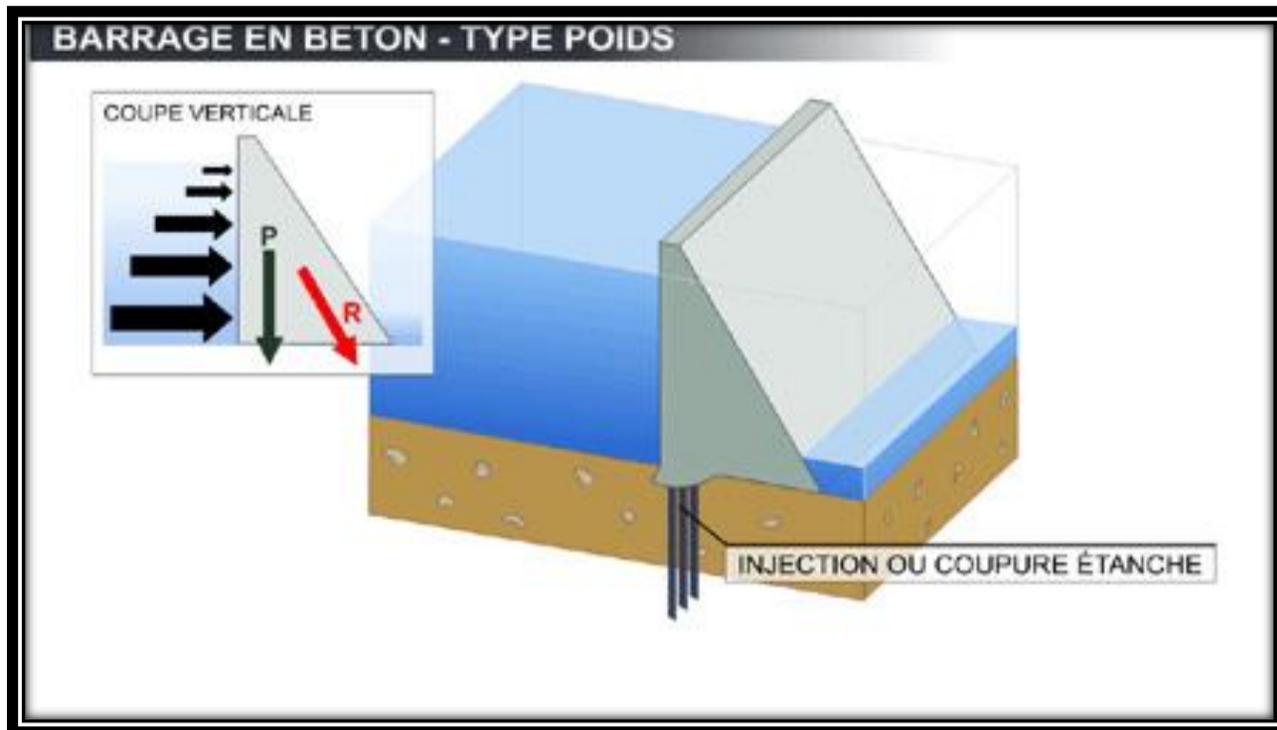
Barrage poids en béton (ANTON ET HENRI, 2011)
